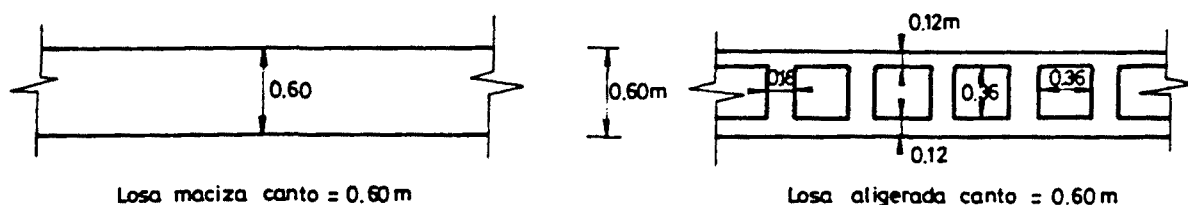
Secciones losa maciza y losa aligerada analizadas.
